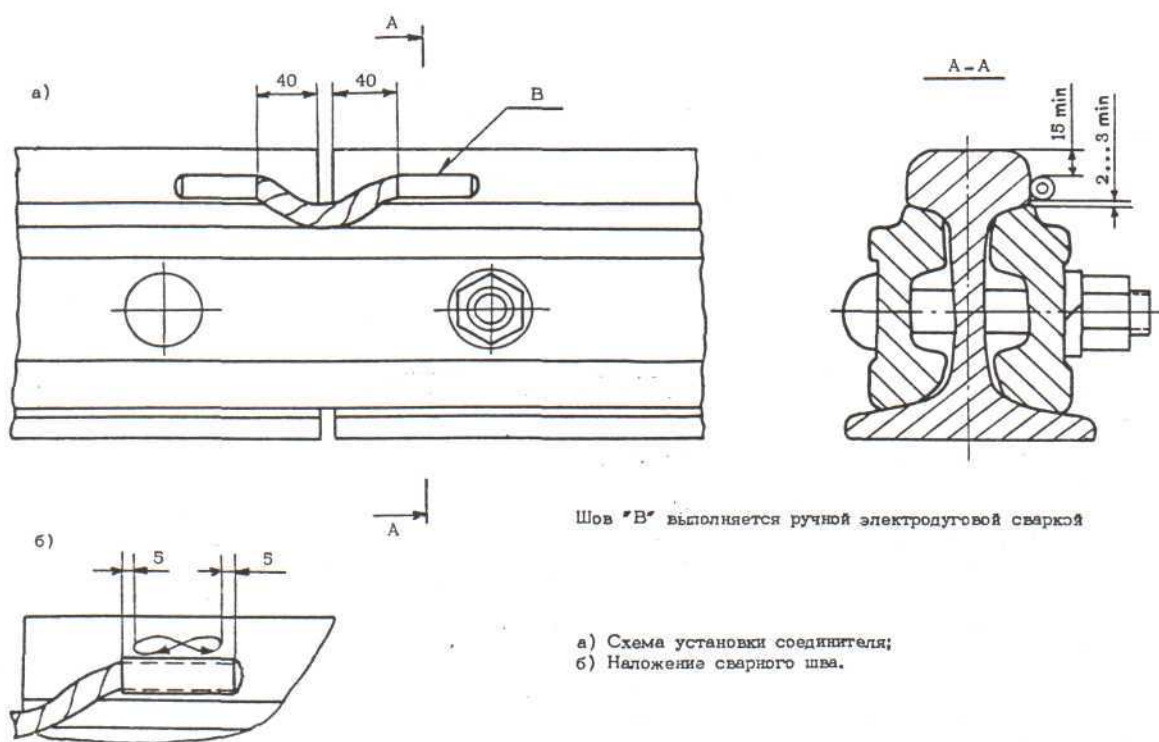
Установка и приварка соединителя с цилиндрическим наконечником по черт. Ц 67.00.00
